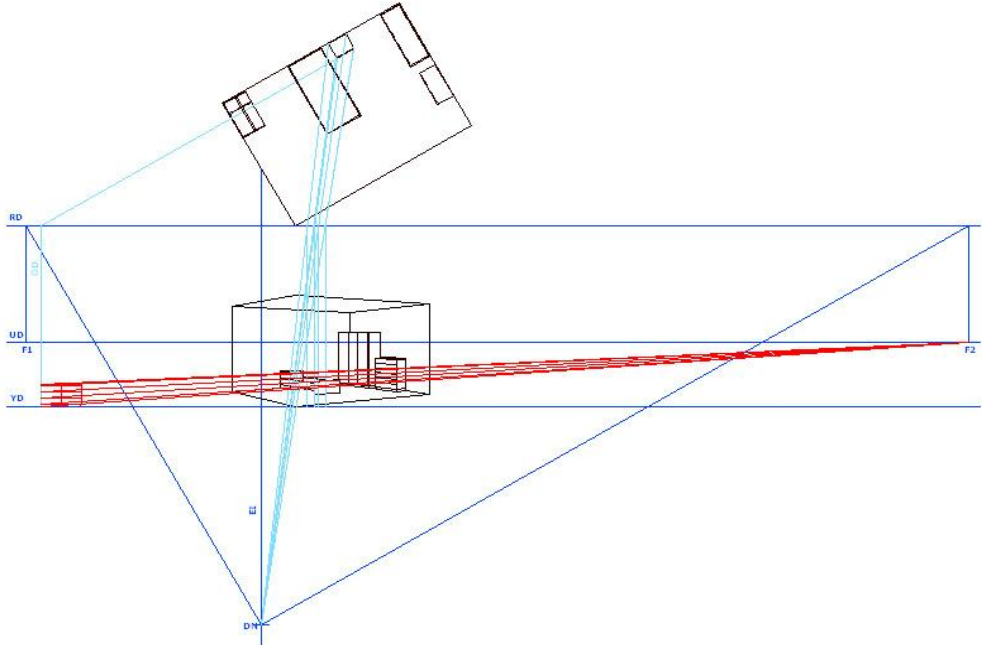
Resim düzlemini kesen ışınların yer düzlemine taşınması
